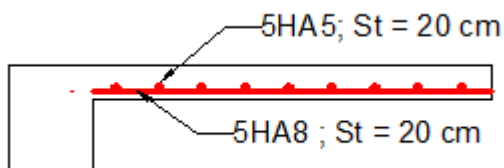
Ferrailage de la dalle sur 2 appuis perpendiculaire type 1.
